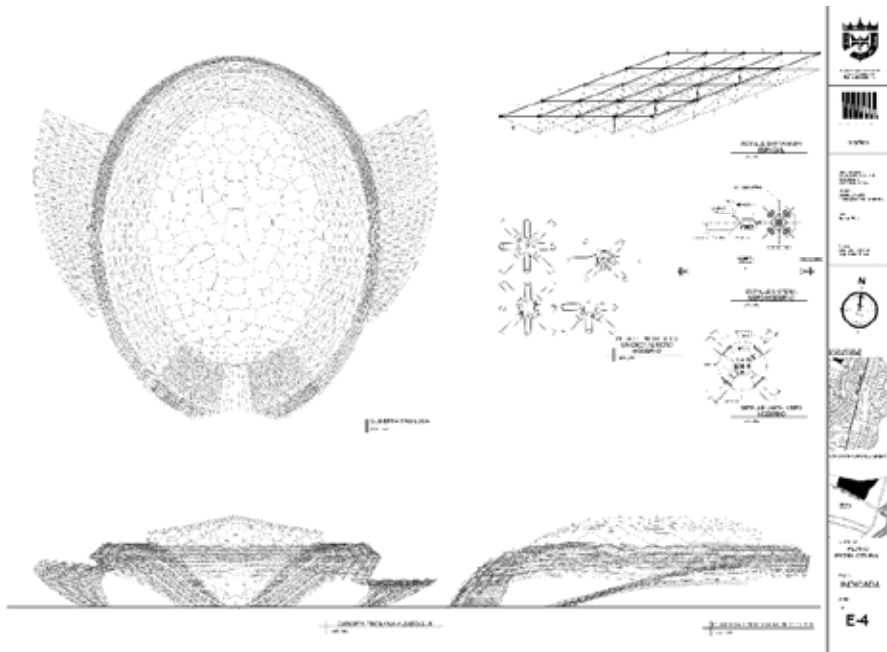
Tridilosa y cubierta. Destalles. Fuente: Autor (2021).
